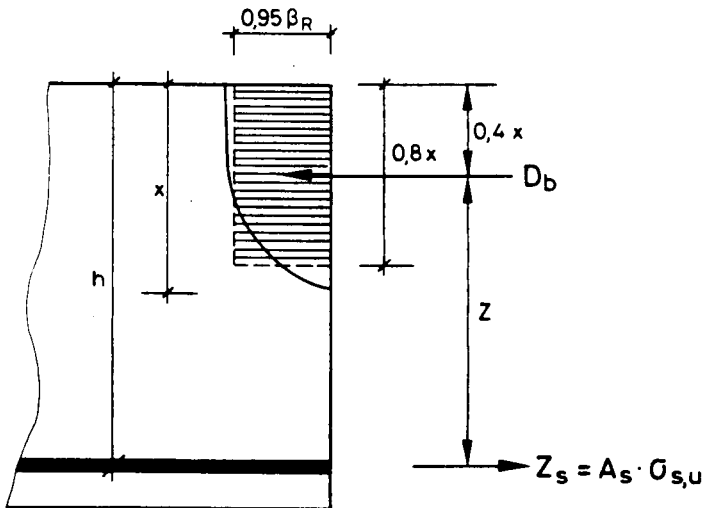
Stahlbetonquerschnitt im Bruchzustand
